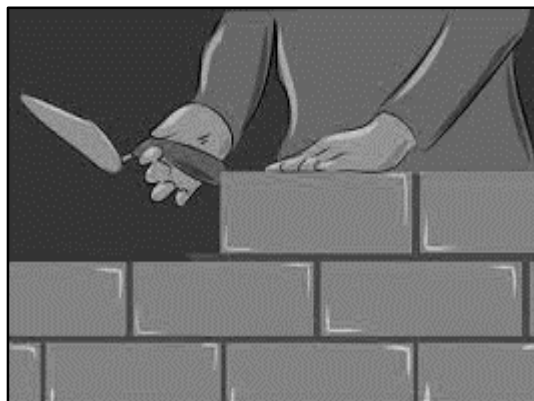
Mampostería No Reforzada, (Jean & Pérez, 2003).
